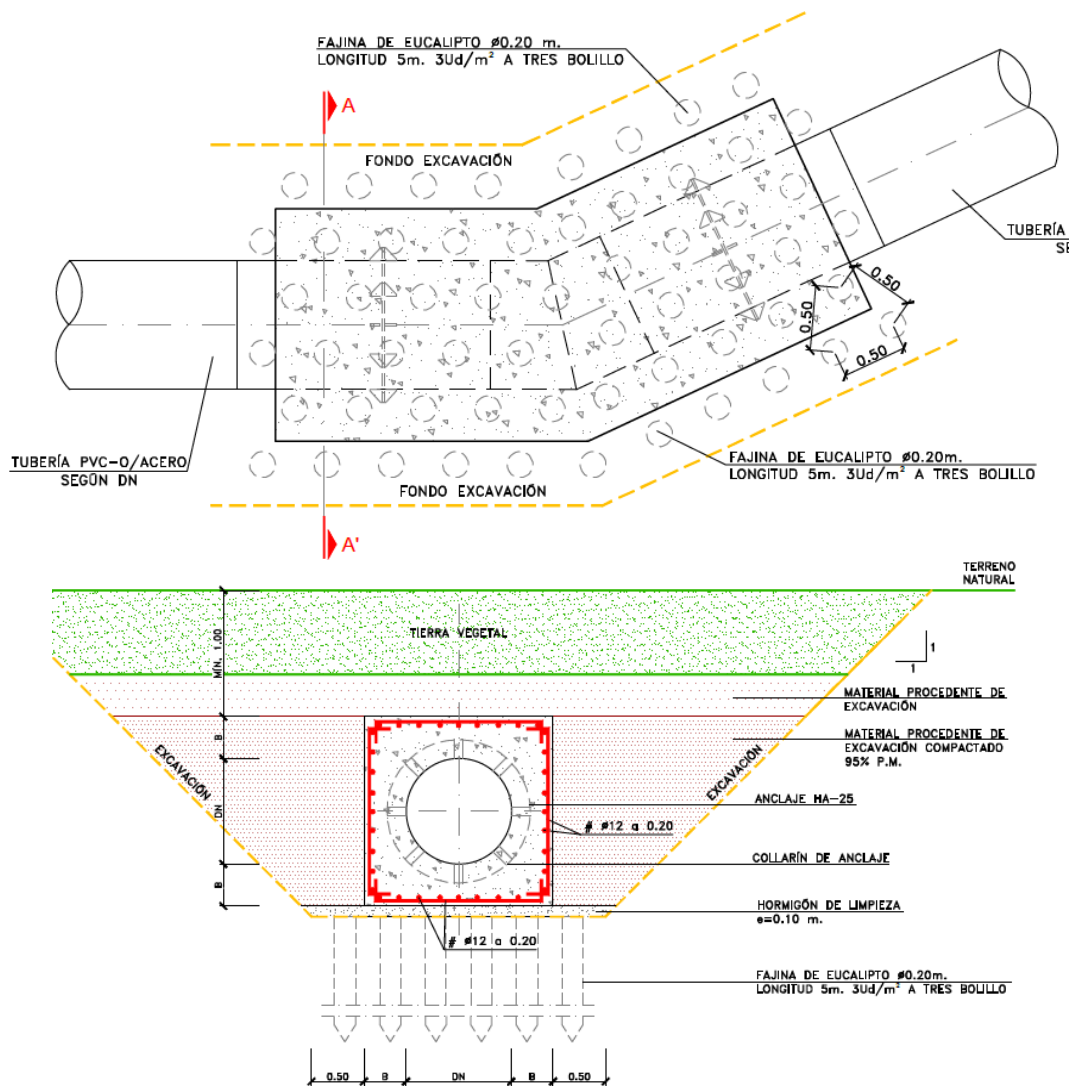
Planta y sección de anclaje tipo para codo de hasta 30°
